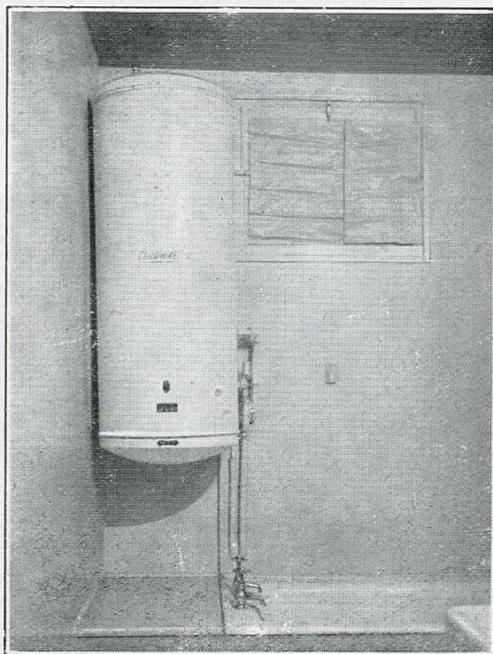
Une salle de bains du groupe équipée avec un chauffe-eau de 100 litres.
